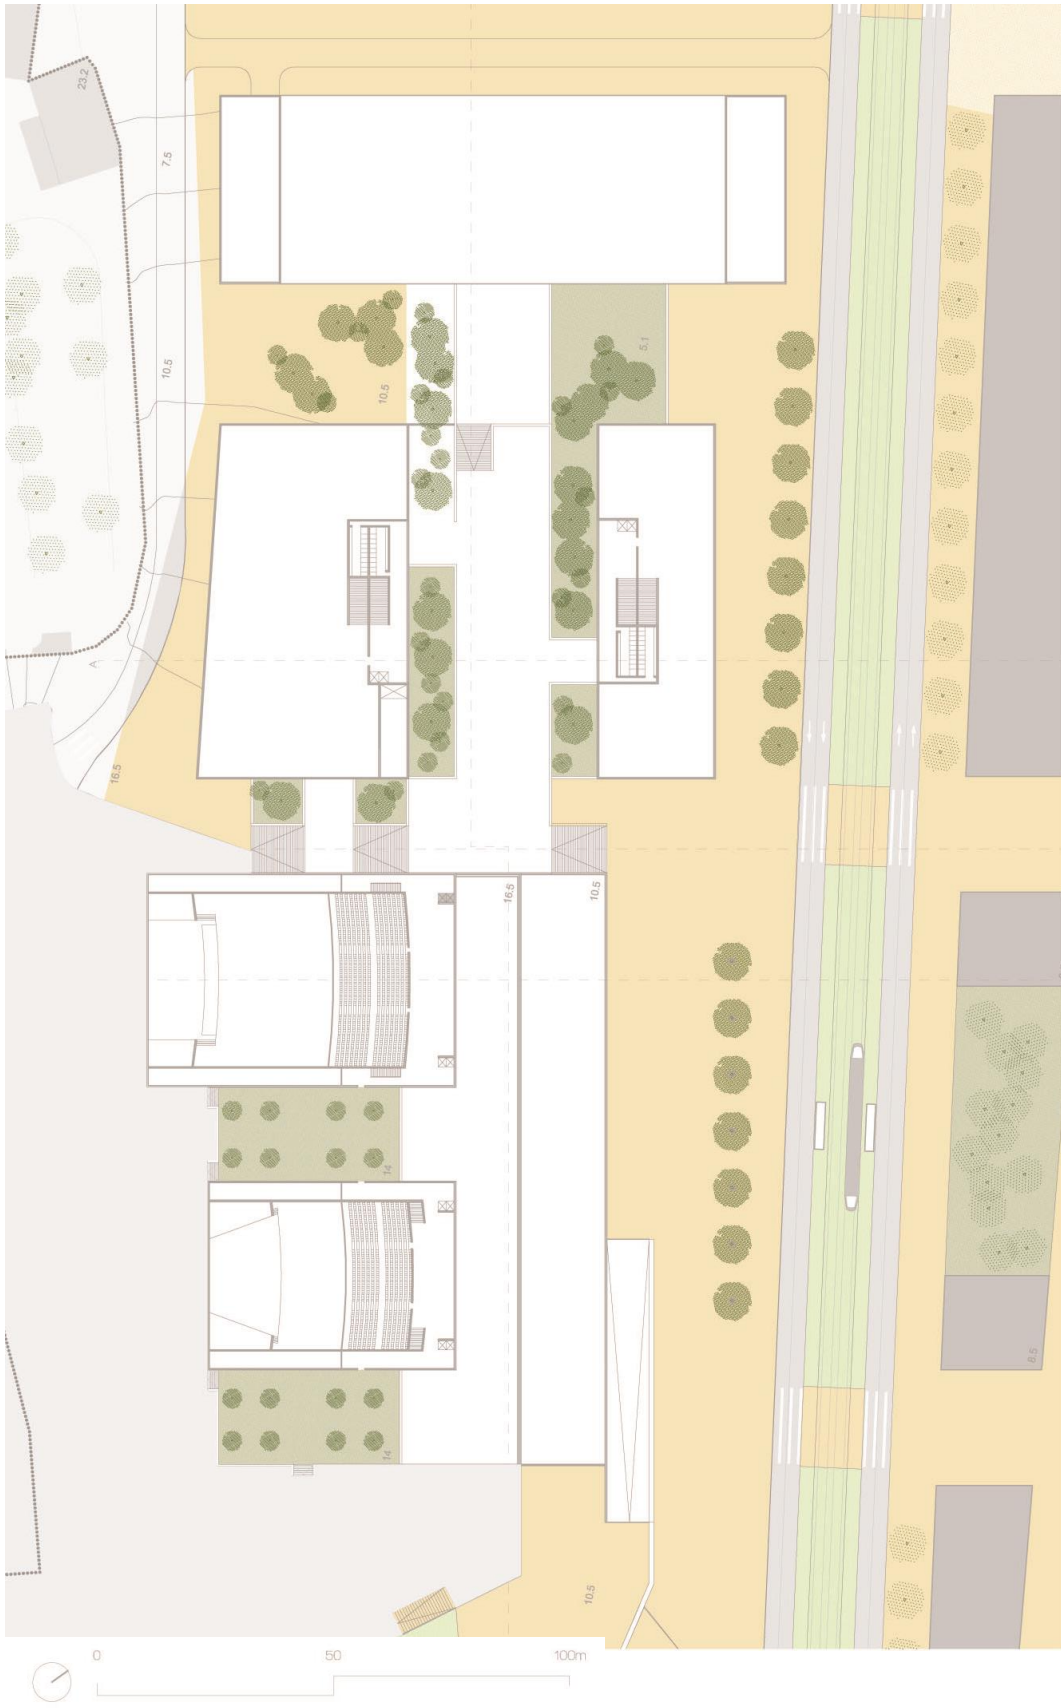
Planta piso 2, cota 16. Fonte: Autora
